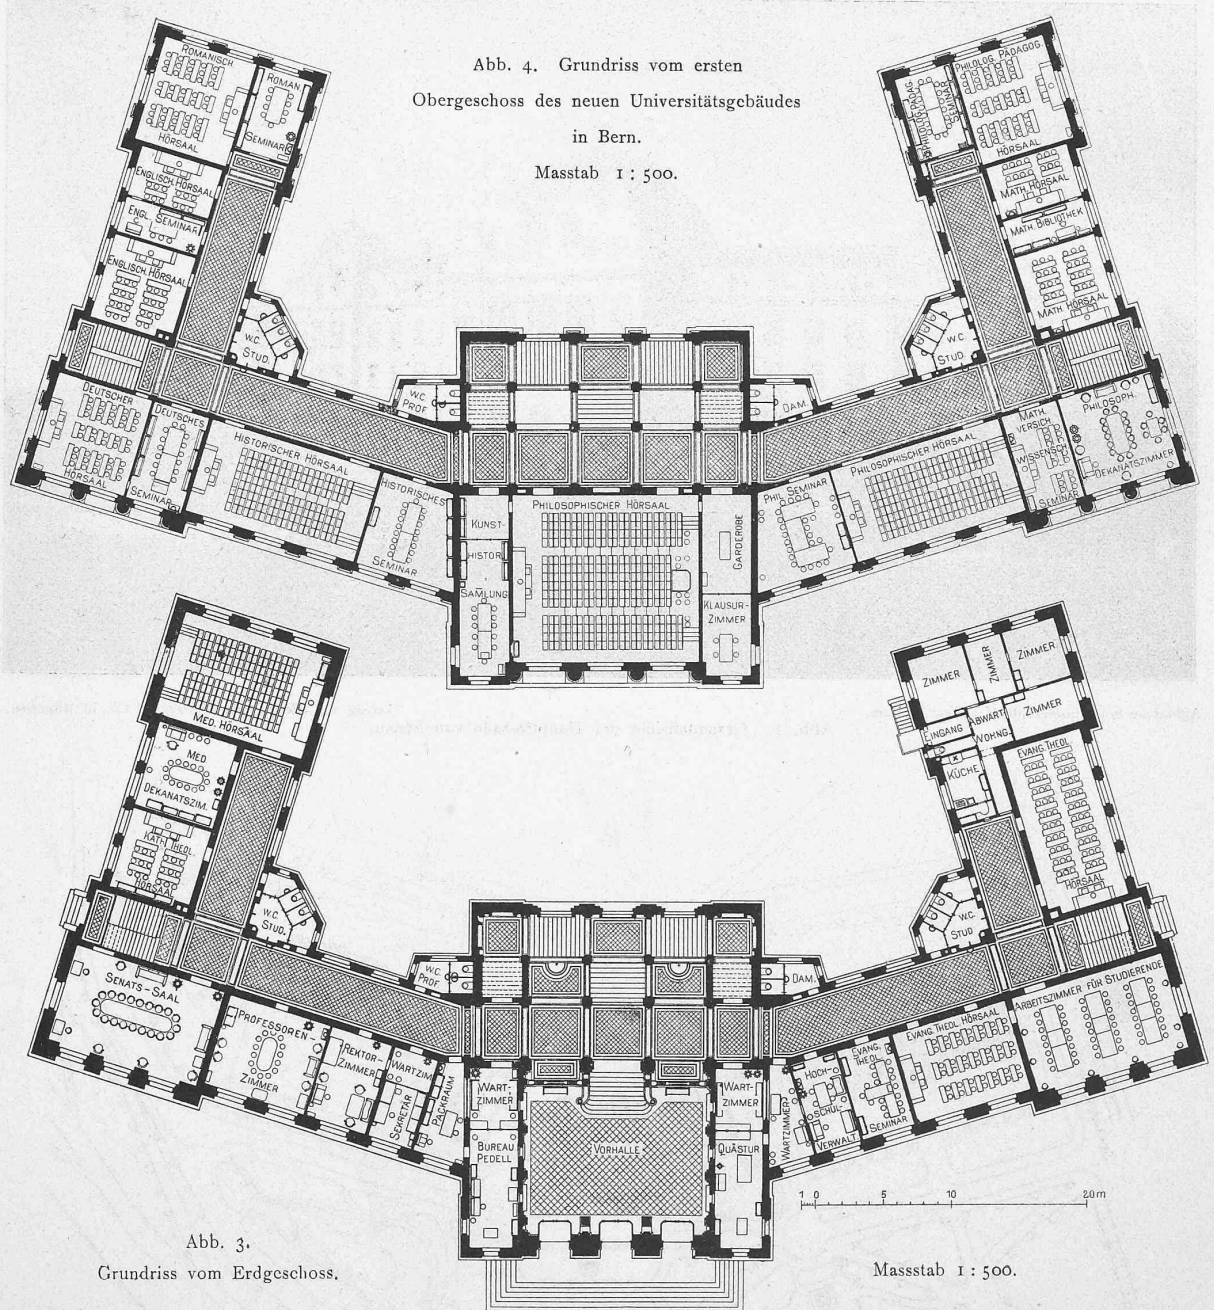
Grundriss vom ersten Obergeschoss des neuen Universitätsgebäudes in Bern. Masstab 1:500.
